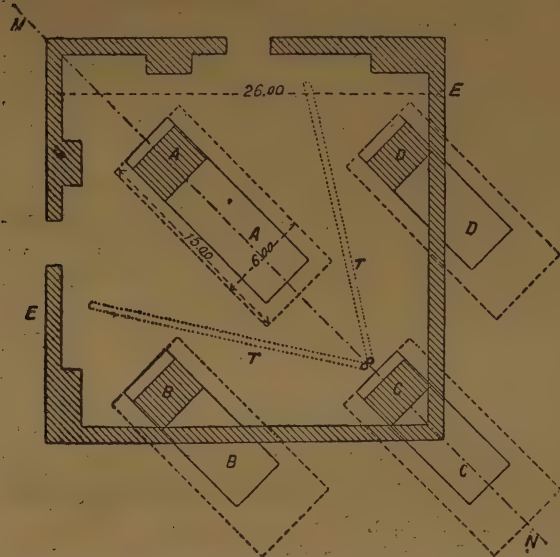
Plans des fondations d'une des 4 grandes piles.
